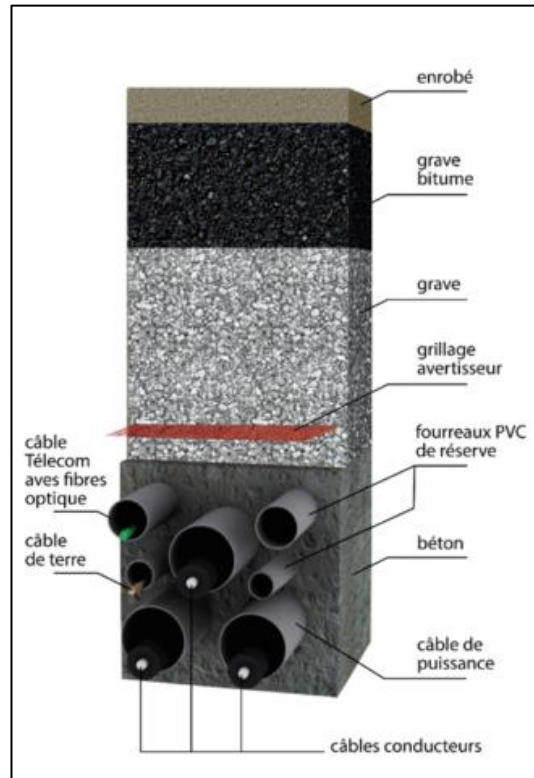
Coupe d'une liaison souterraine de câbles en fourreaux PVC (milieu urbain)
